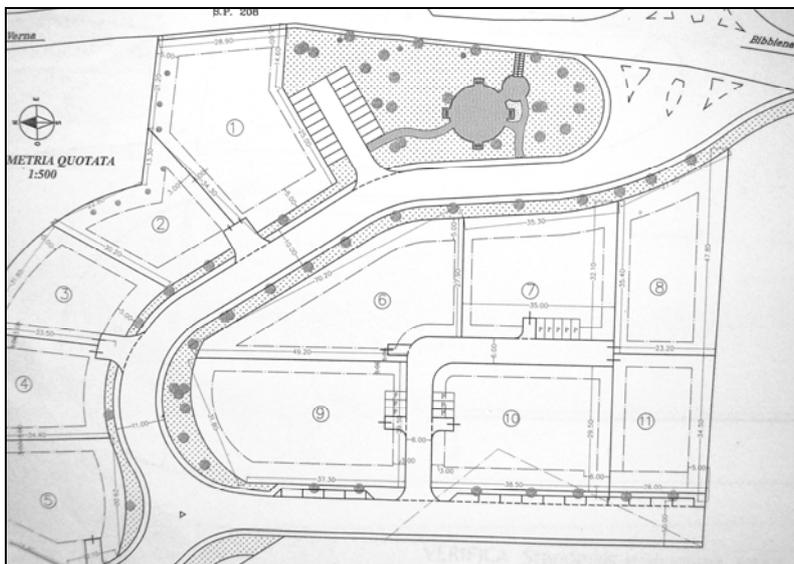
Planimetria. Proposta presentata nel settembre 2006
